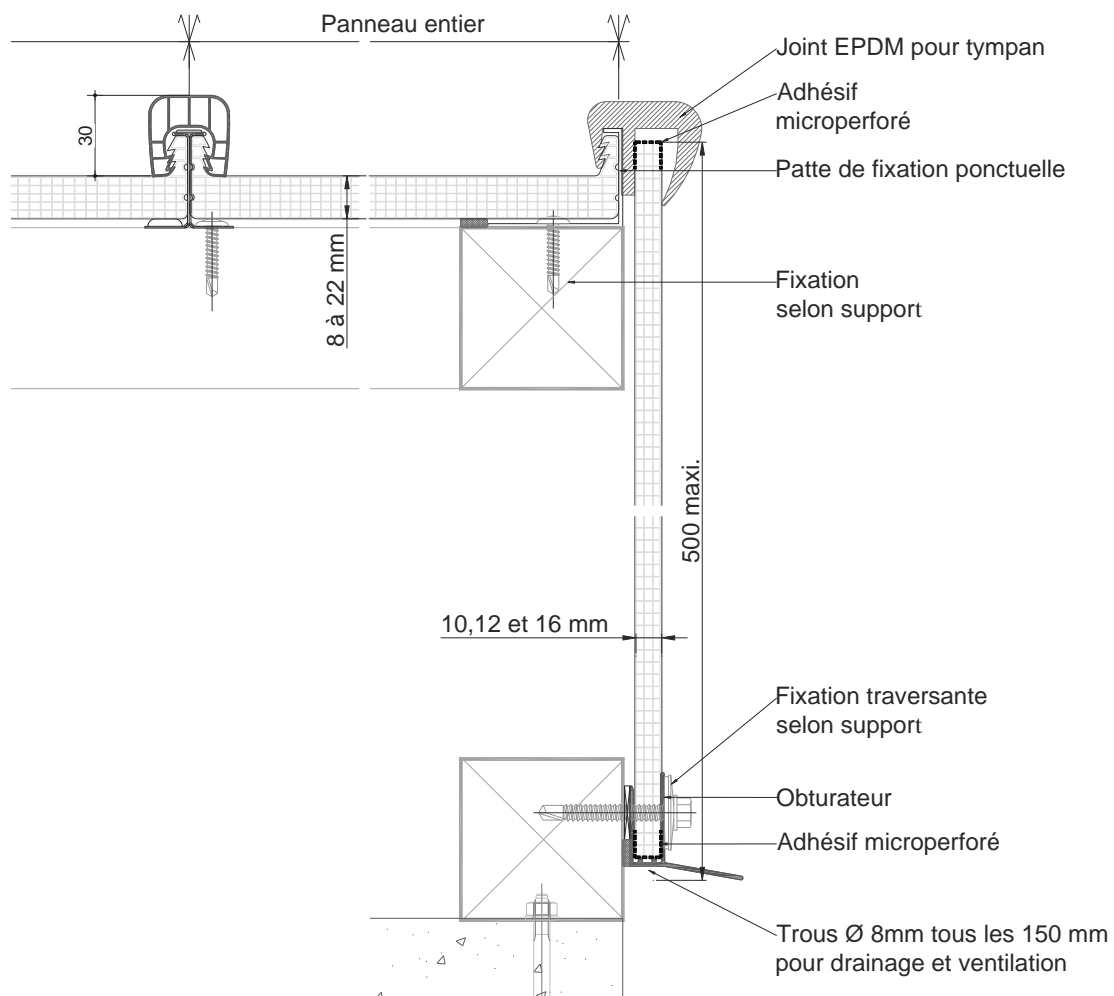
Rive sur tympan – système DANPAVOUTE
